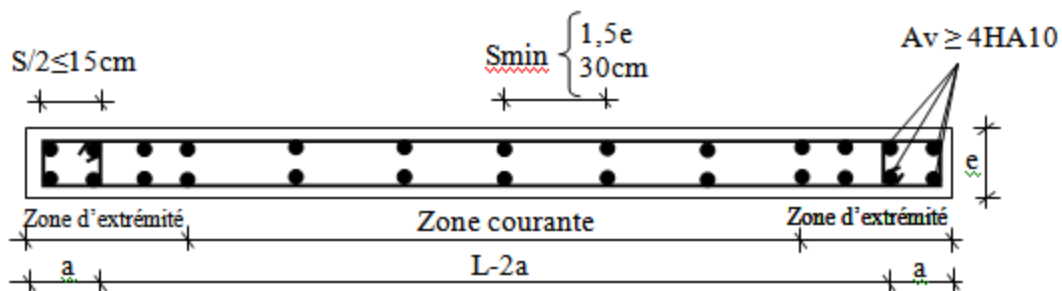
Disposition des armatures verticales dans les voiles trumeaux
